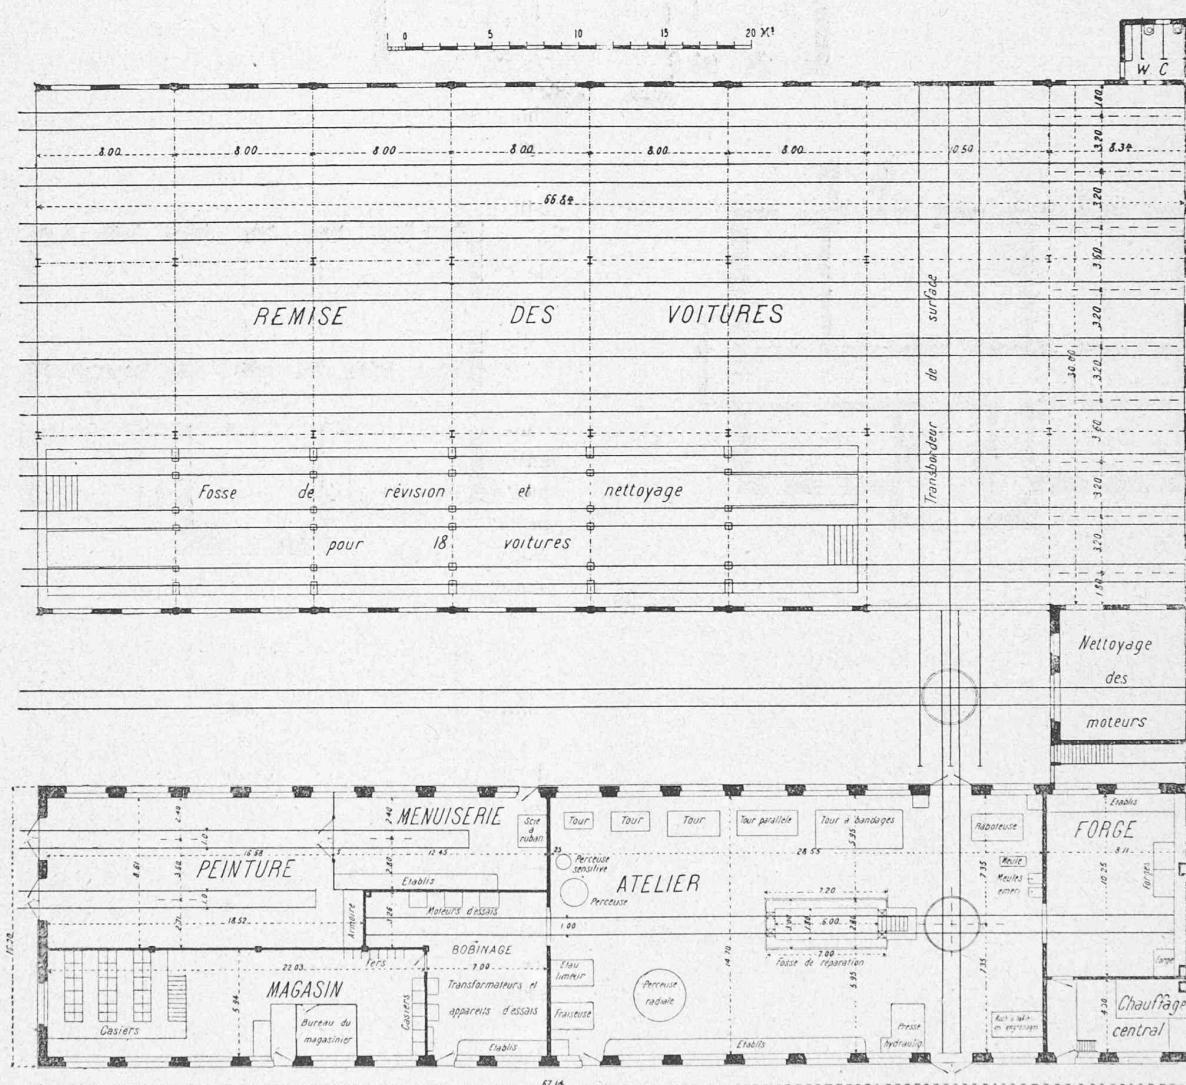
Plan des remises et ateliers des Tramways lausannois, en Prélaz.
